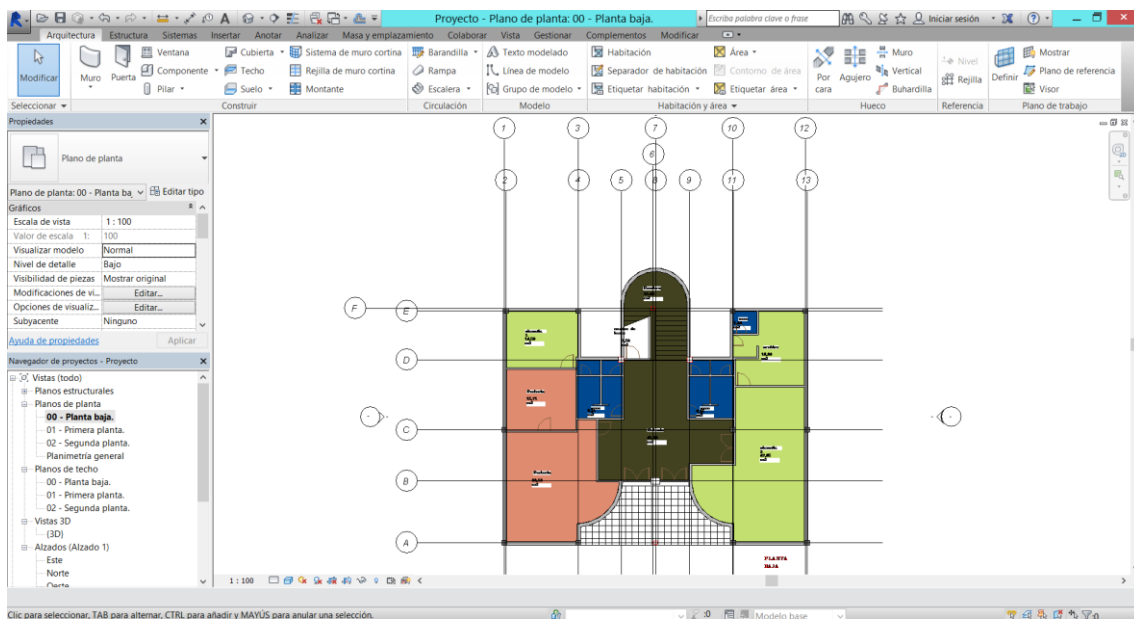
Plano de planta: 00 - Planta baja con los pilares rectangulares hormigón 300 x 300 mm. Fuente: Elaboración propia.
